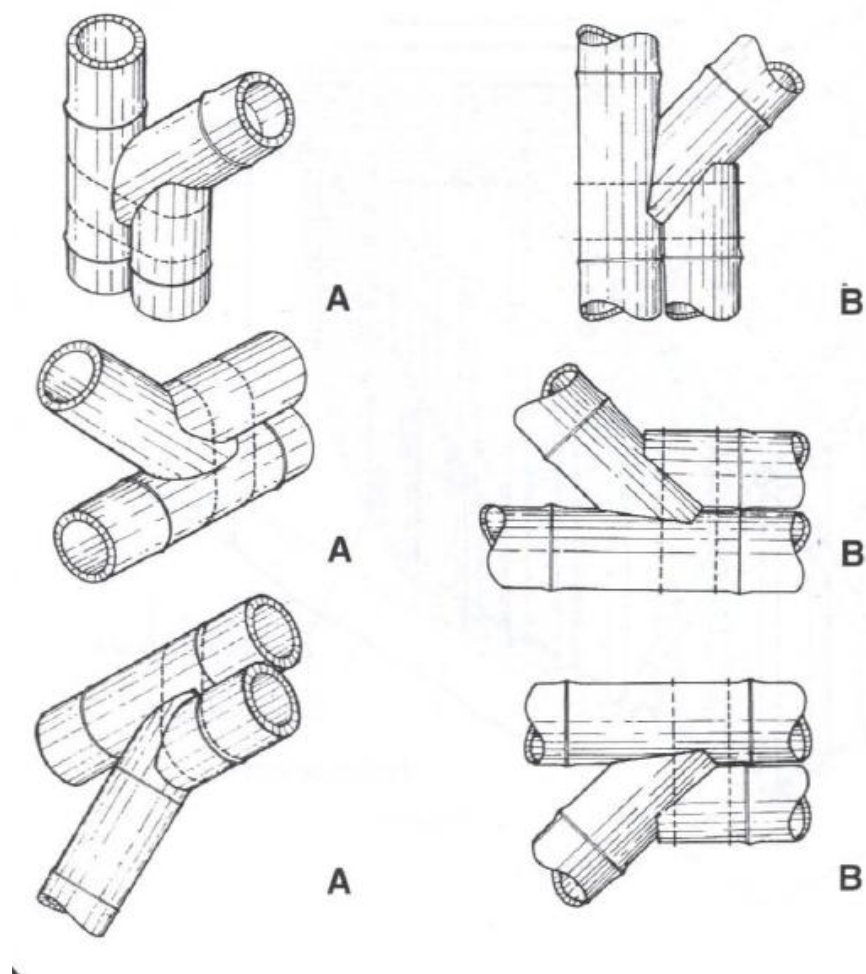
Detalhes de encaixes Boca de Lobo. A – Isometria e B – Vistas
